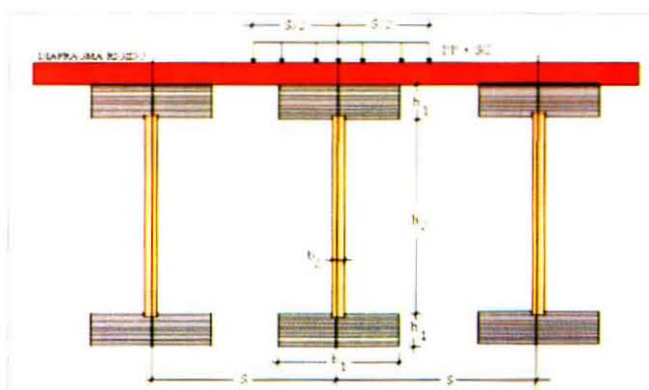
Distribución de vigas compuestas de piso separadas transversalmente a S.
